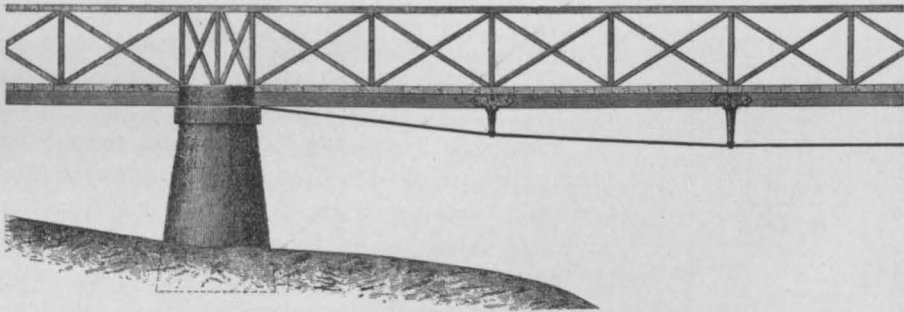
Fußgängersteg über den Whitadder bei der Abtei St. Bathaus. 1840.
